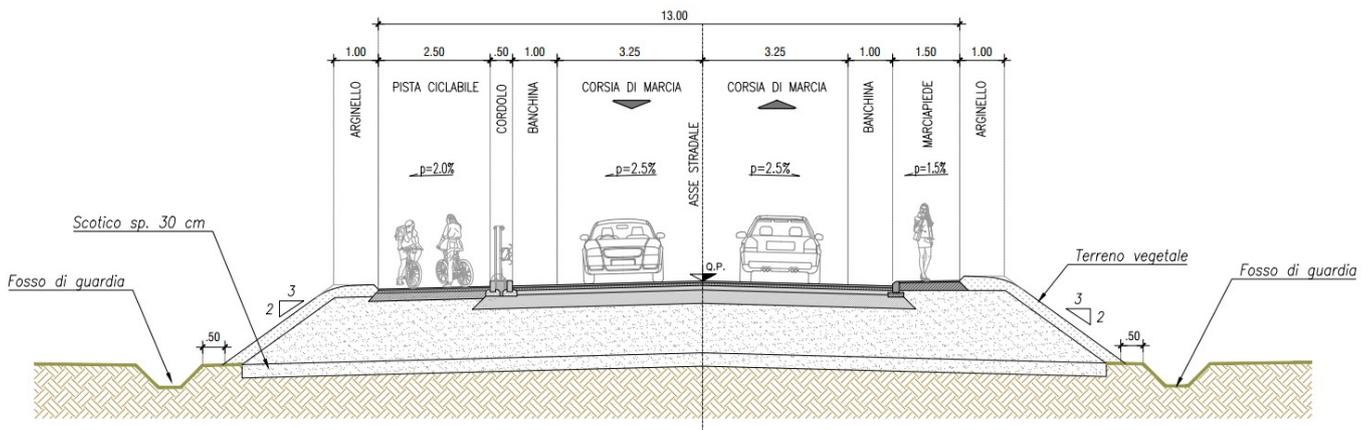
sezione tipo in rilevato (H ≤ 5,00m)
